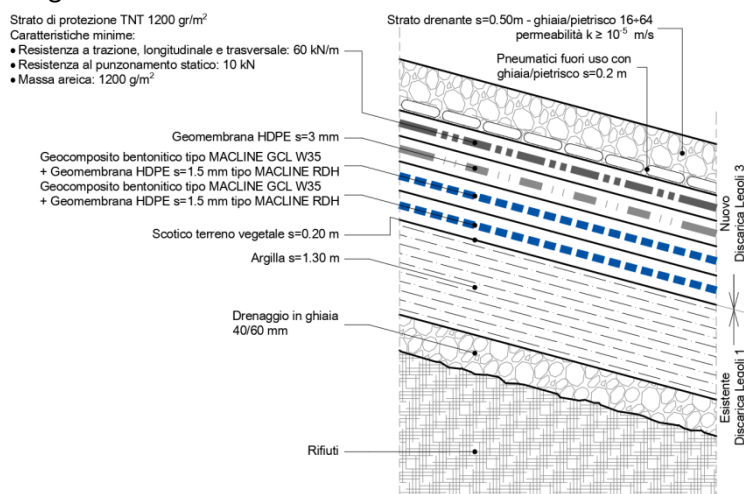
Particolare E – Barriera sopra copertura Legoli 1
